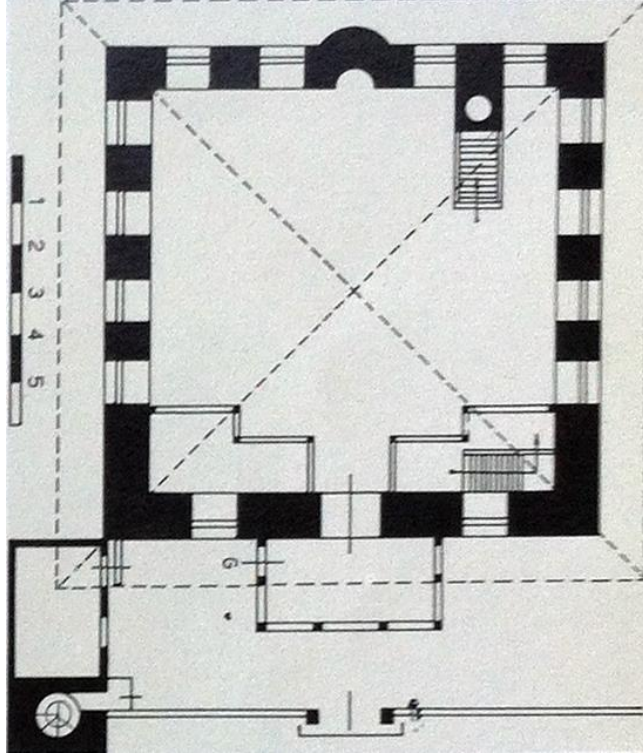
29.: Haluk Sezgin tarafından çizilen Beylerbeyi Camii planı (Çelik, 2000, s.210)
